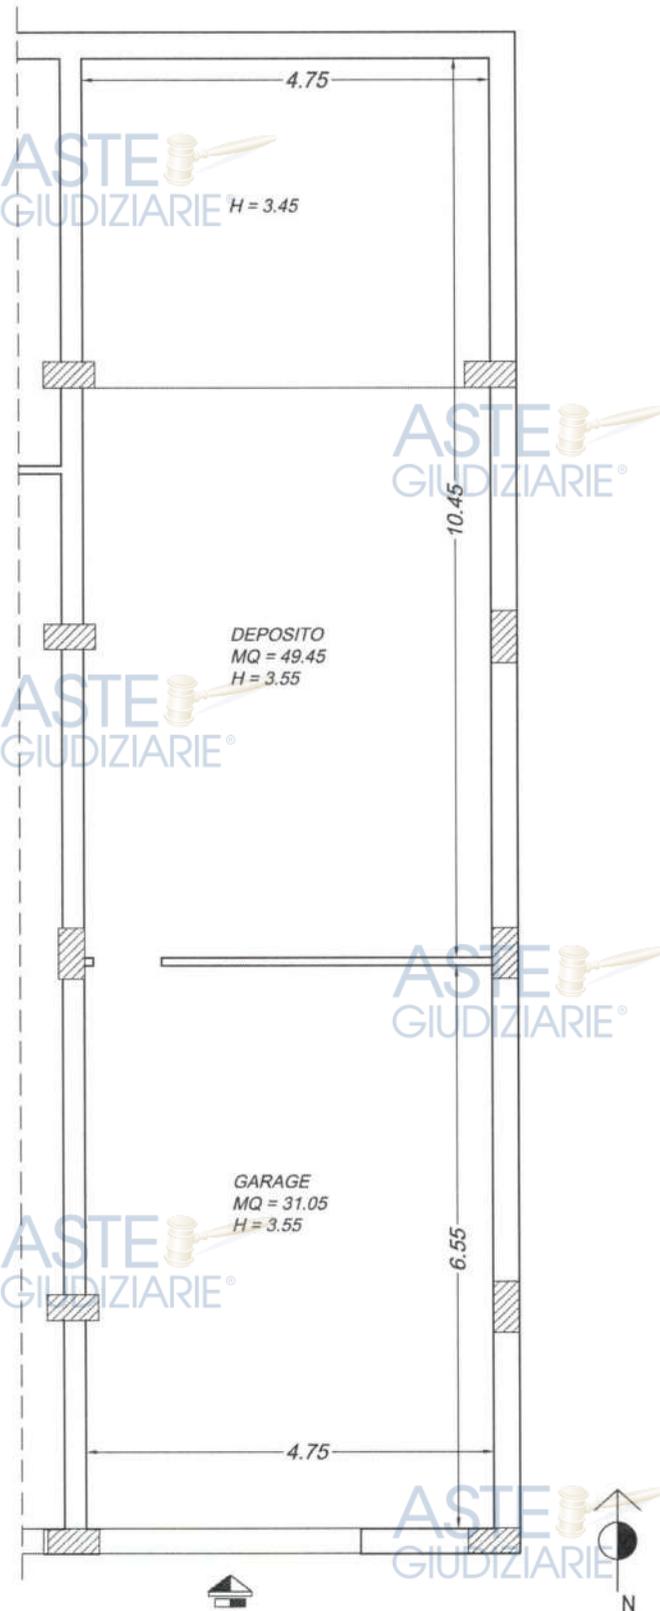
Planimetria Stato di Fatto Foglio 23, p.lla 371, sub 5 (ex sub 2) – Piano S1
